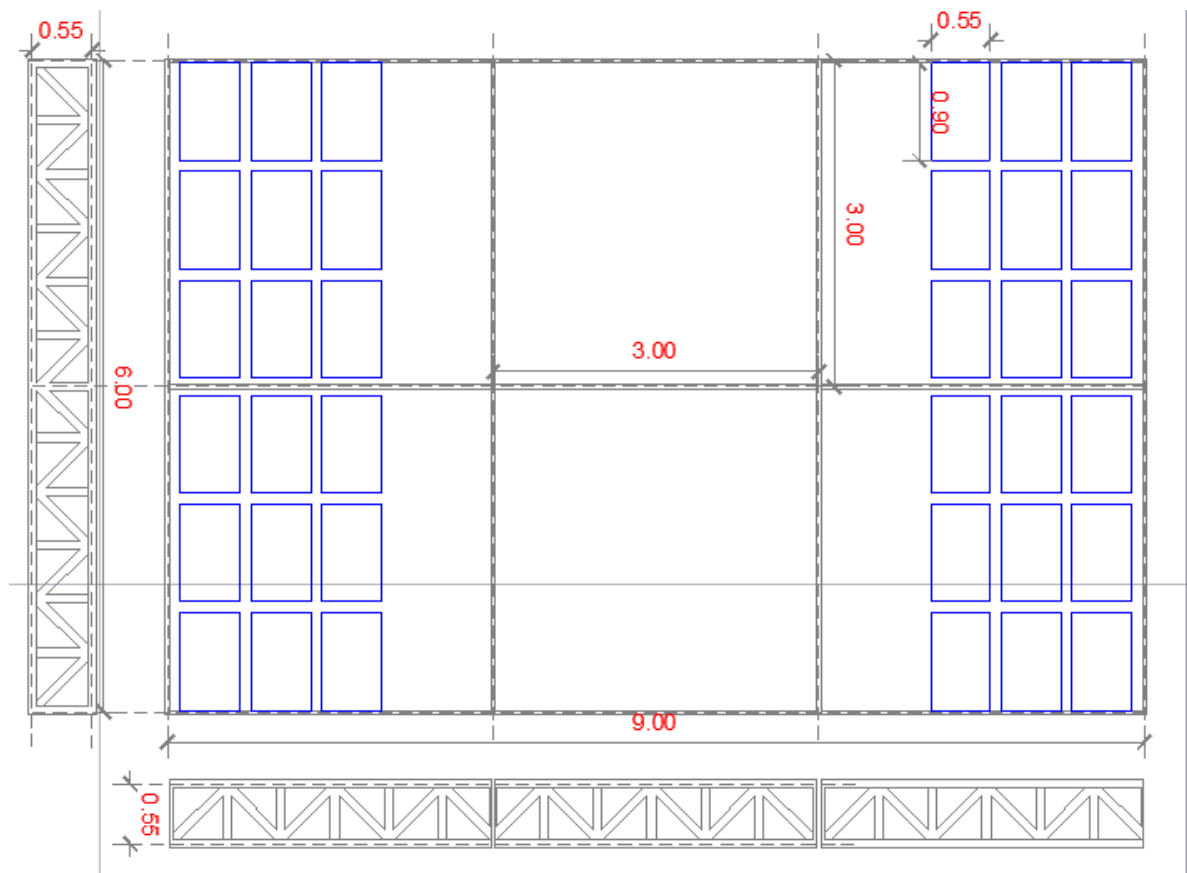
, Vista en planta y vistas laterales - Base flotante
